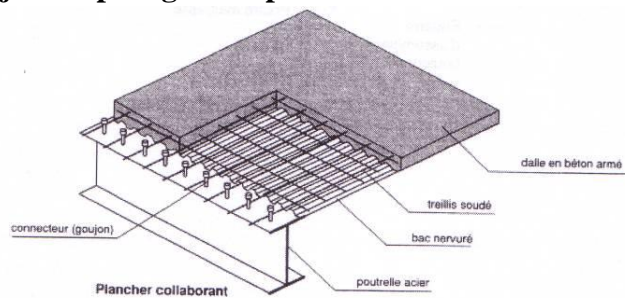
schéma explicatif du plancher collaborant avec des poutres en acier
